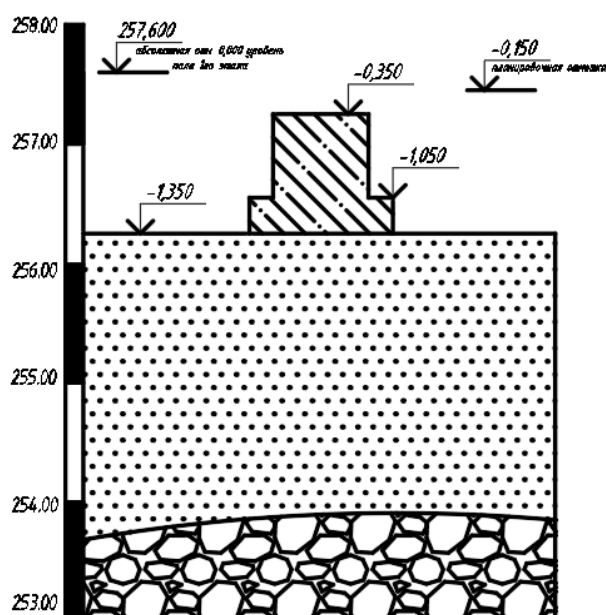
Схема расположения фундаментов, относительно отметок
